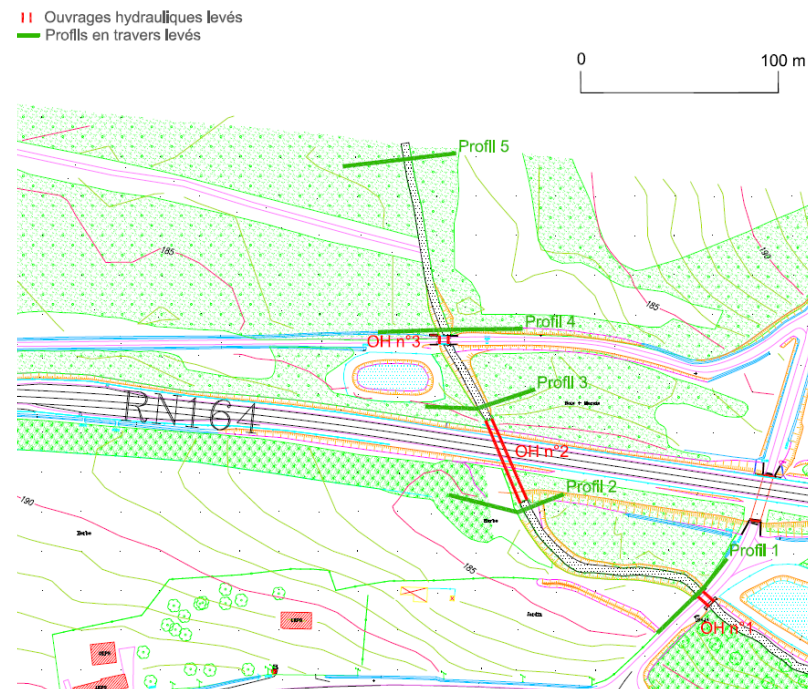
Localisation des levées topographiques et des ouvrages hydrauliques
